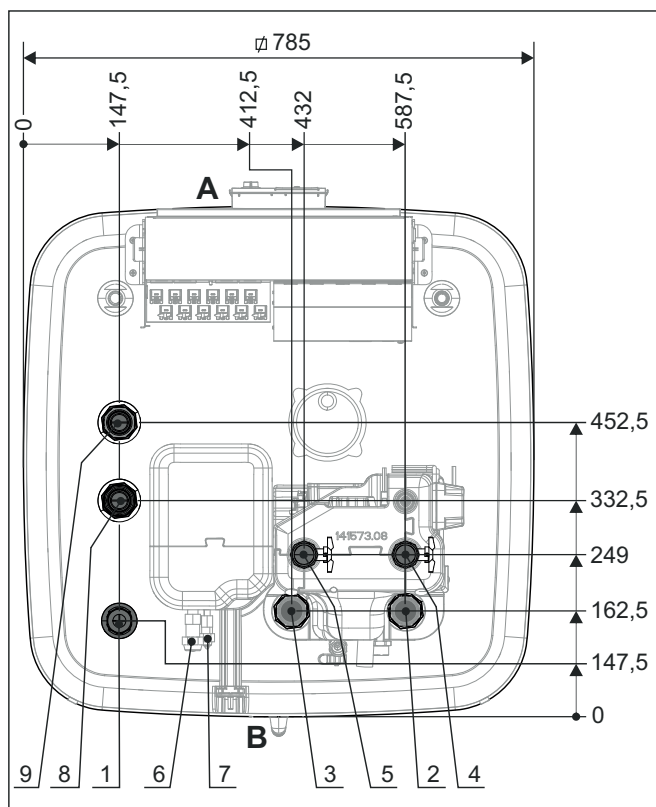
Dimensiones, lado superior del dispositivo - Tipo ... 04P50D/...08P50D
